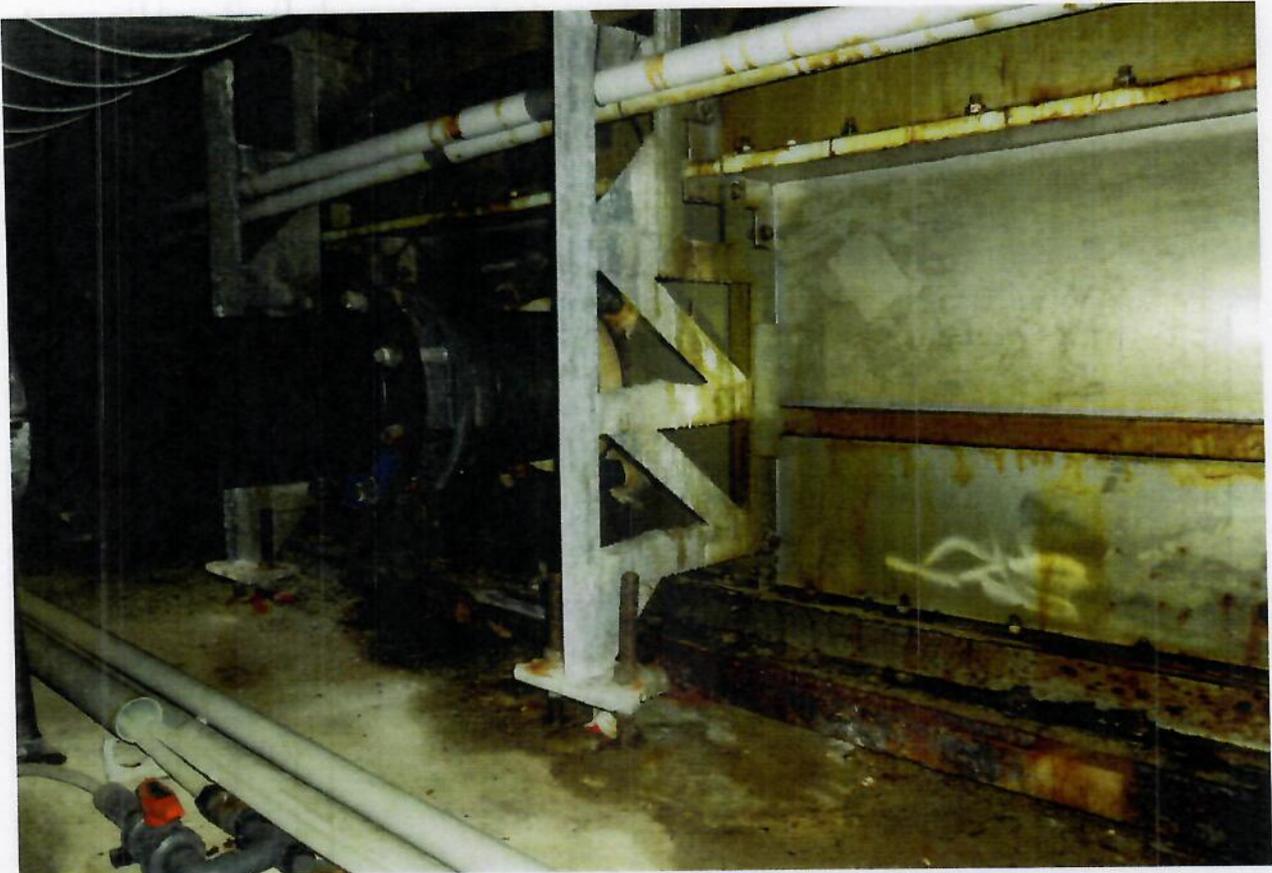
\_Badewassertechnik 10: Beckenverrohrung Bestand
